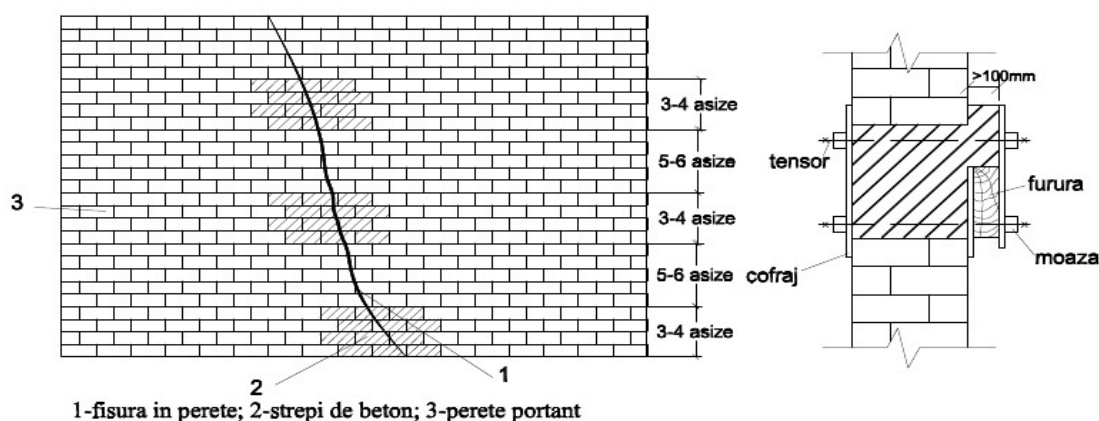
Consolidarea zidăriei cu ștrepi din beton.
